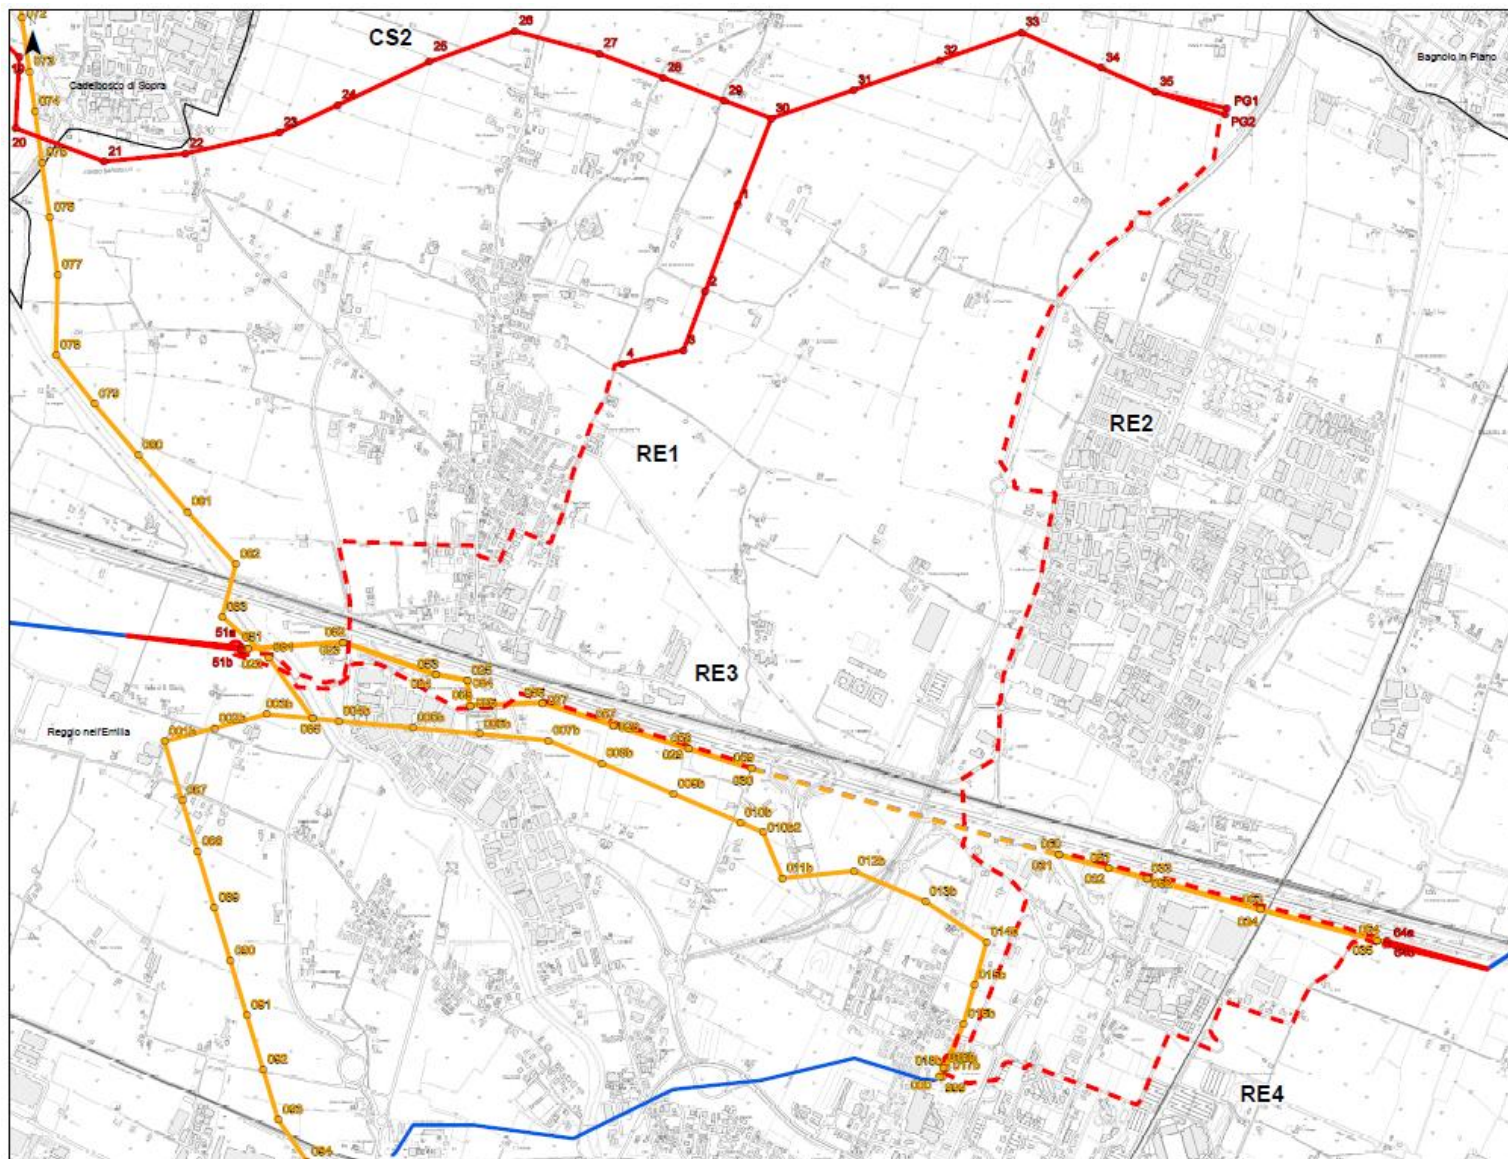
Planimetria progetto 31/01/2021 (tratta da elaborato Terna DU0000006B1937737)
